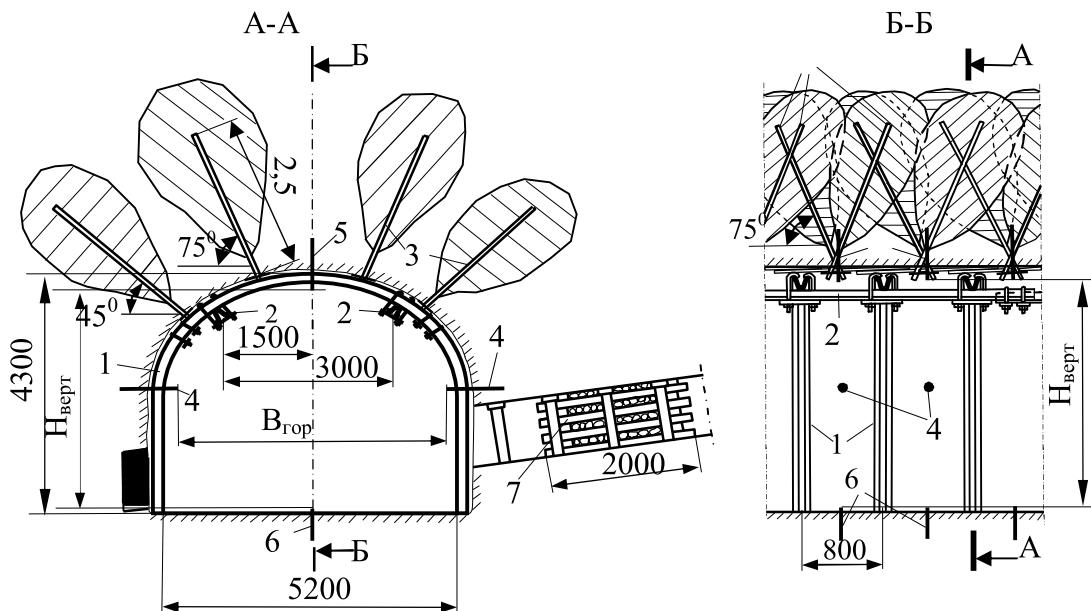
Конструкция двойной продольно-балочной крепи из СВП-27 в сочетании со сталеполимерными анкерами: 1 – арочная крепь; 2 – продольная балка; 3 – сталеполимерные анкеры; 4, 5, 6 – соответственно боковые, верхний и нижний контурные реперы; 7 – буто-костер
